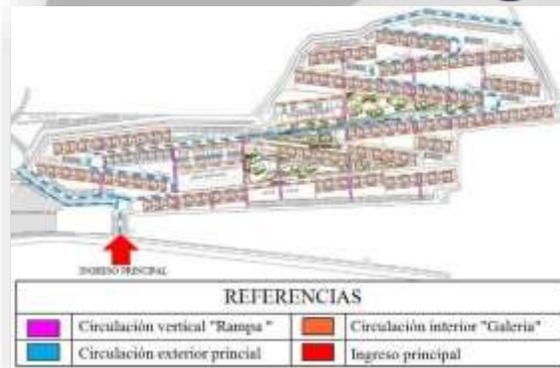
BRISA CANTÁBRICO – Planimetría.
